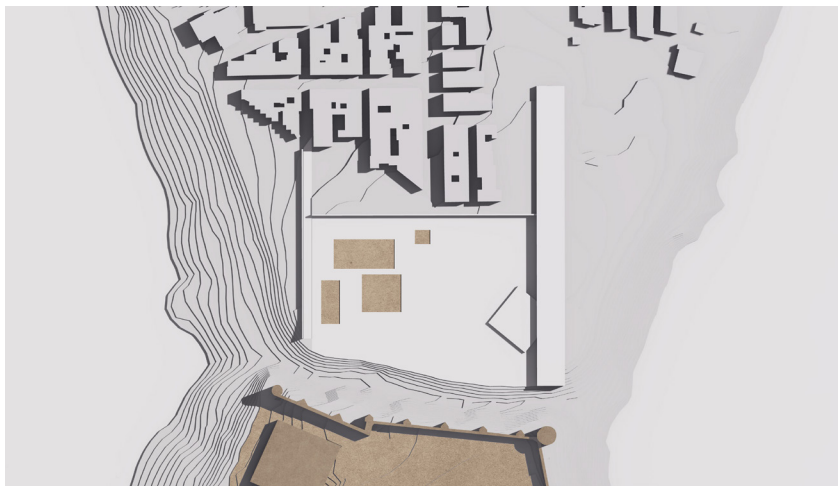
Lucera. Progetto per l'area archeologica antistante il Castello: planivolumetrico e pianta generale di progetto.
